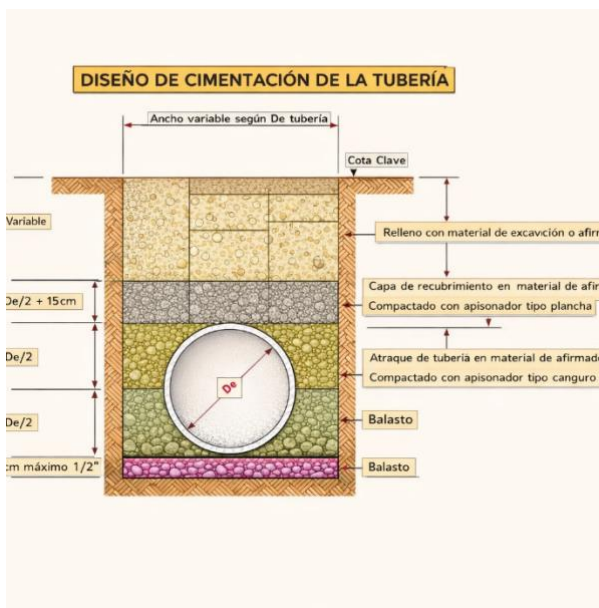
Estructura típica de atraque o cimentación de tubería de sistemas de alcantarillado [14].
